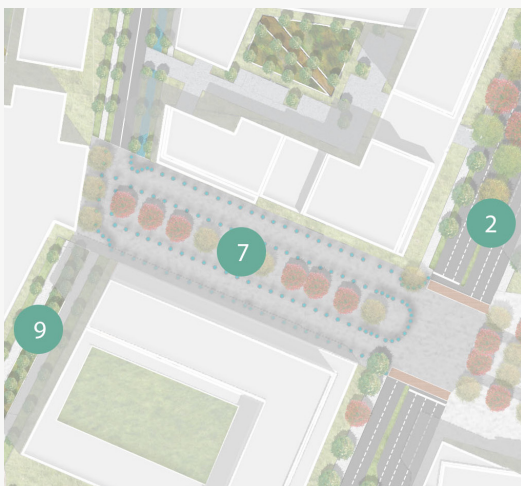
Plan image détaillé - Boulevard Albert-Einstein
